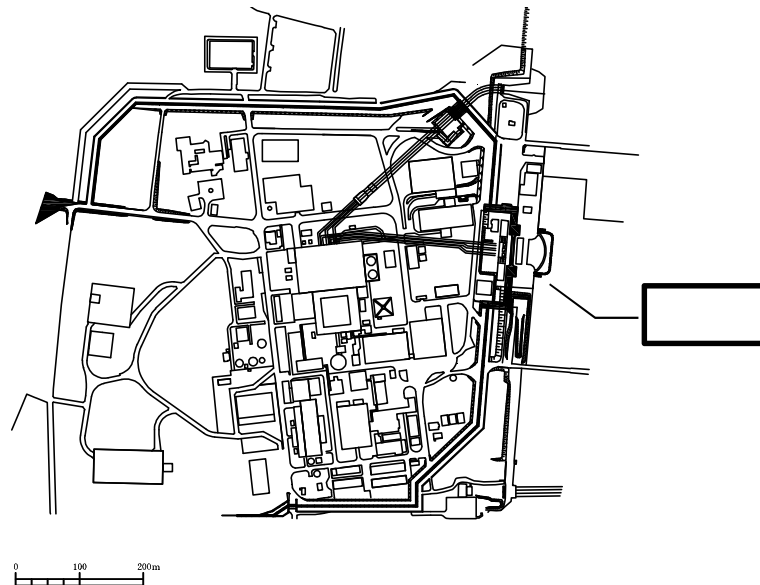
(1) 貯留堰の平面配置図（全体図）
